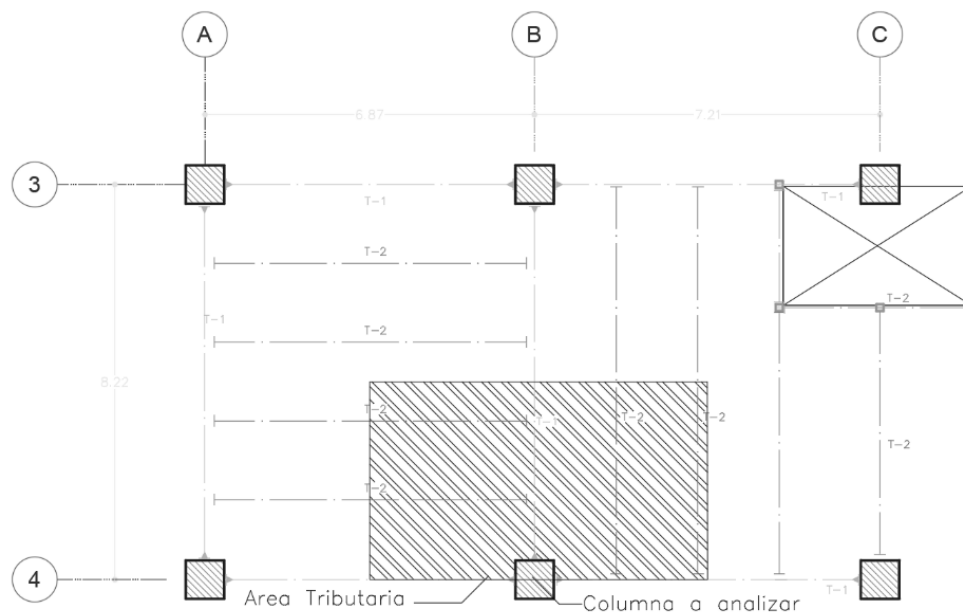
Croquis de localizacion de Columna C-1 a analizar.
